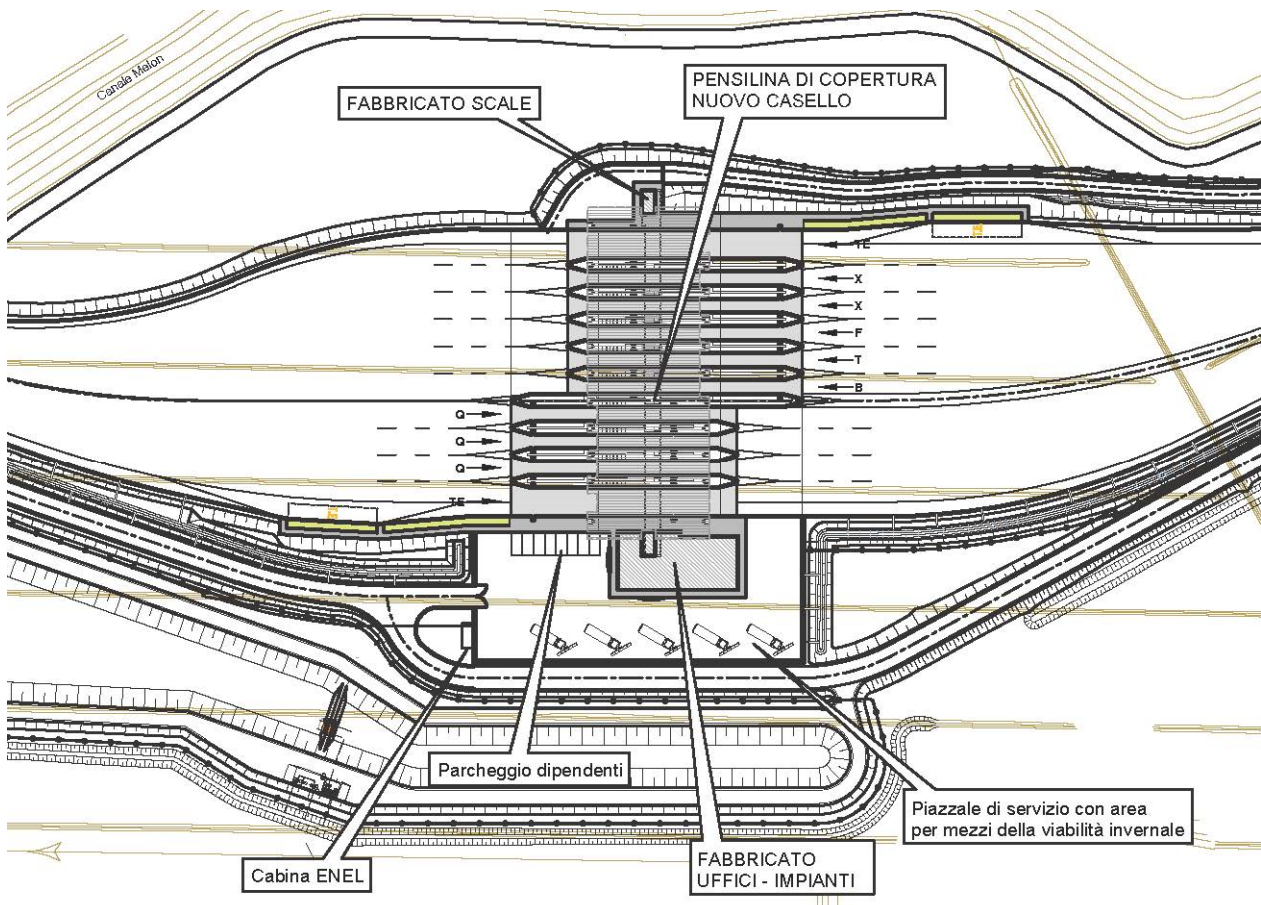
planimetria del piazzale di stazione con indicazione delle strutture del nuovo casello
